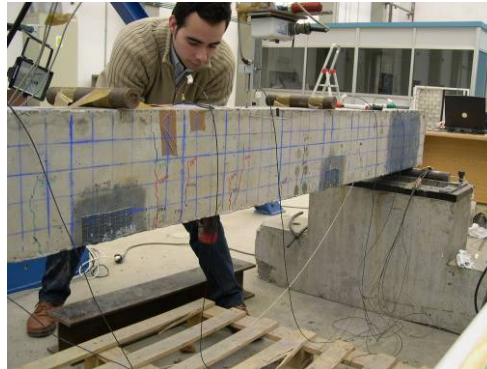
Aplicación de técnicas de detección de daño a vigas de hormigón armado reforzadas externamente.
